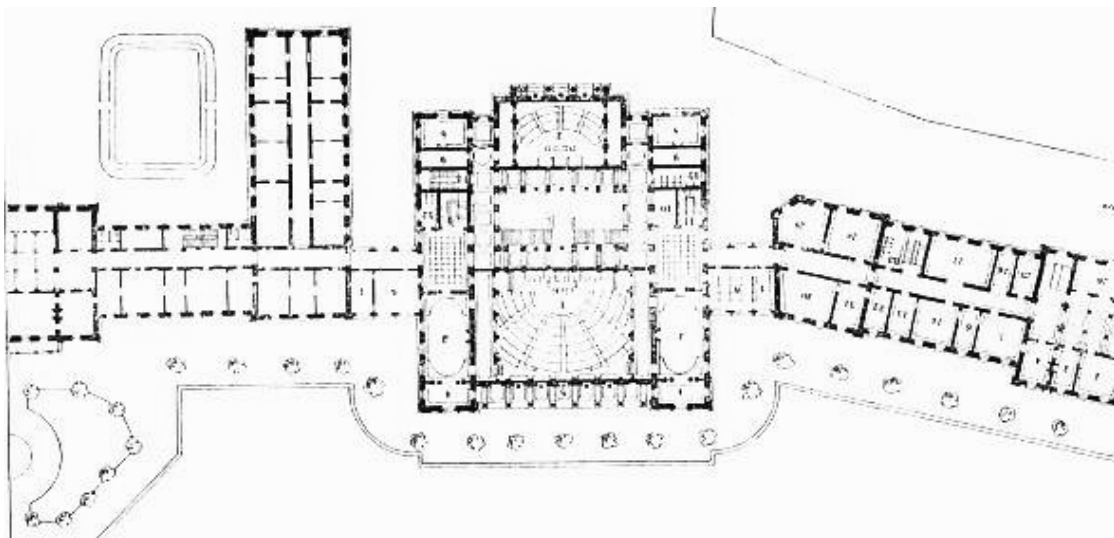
Situationsplan, Hirsbrunner/Baumgart.
